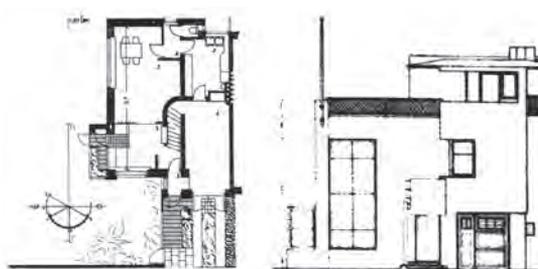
Disegni della pianta del piano terra e del prospetto della Casa a Niegolewskiego Street.
